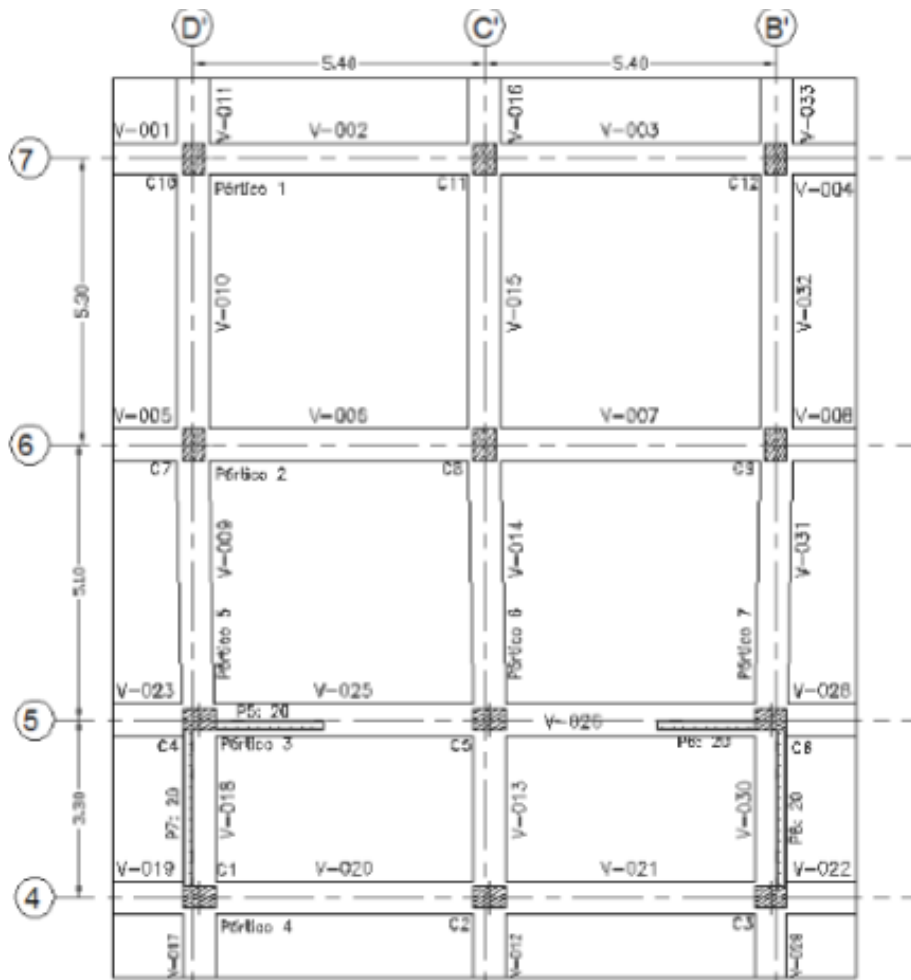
Planta de Cimentación Bloque B Torre Típica.
